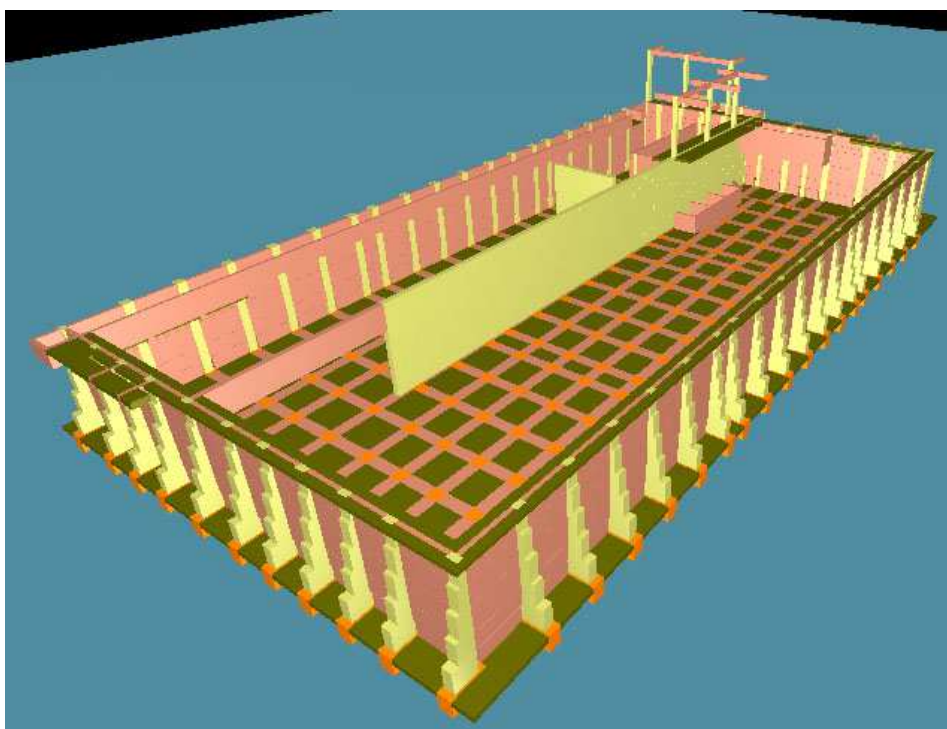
Vista tridimensional do modelo estrutural de outra visada.
